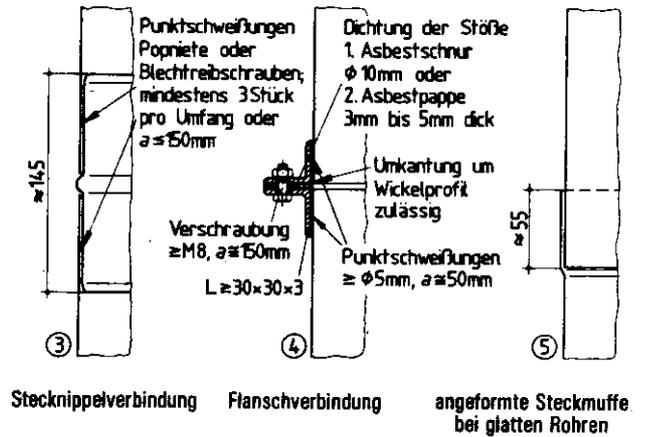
Stoßverbindungen von Rohrleitungen (Maße in mm)
